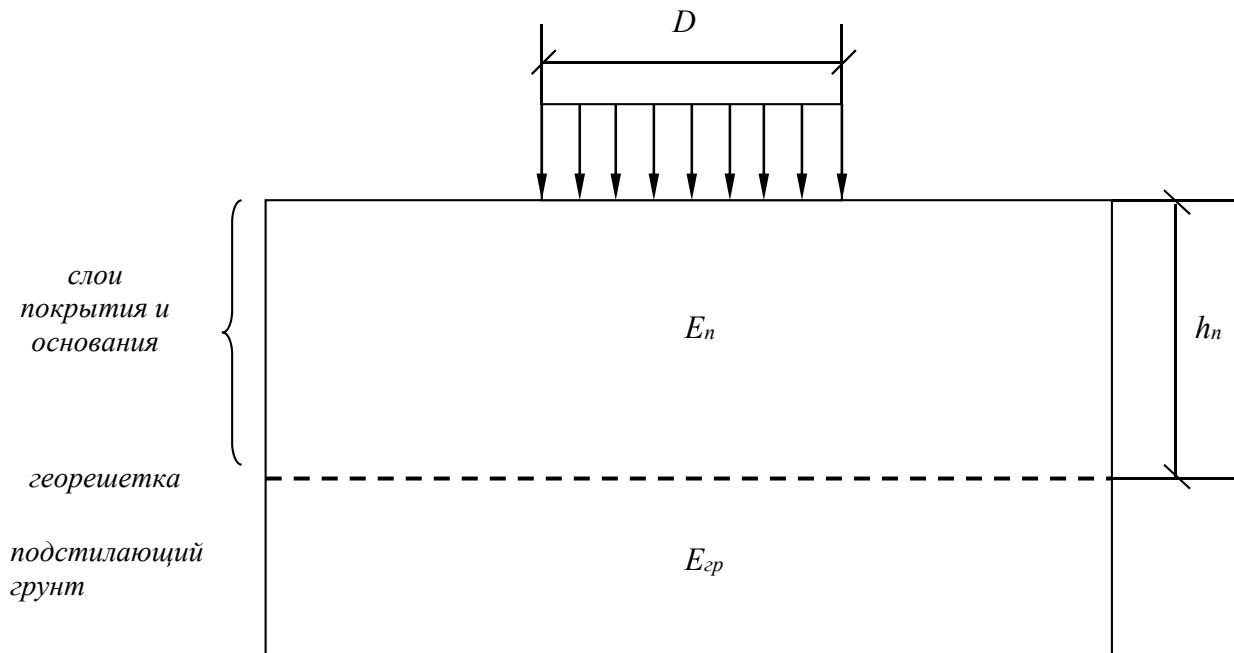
Расчетная схема дорожной одежды переходного типа, армированной георешеткой серии ТХ
